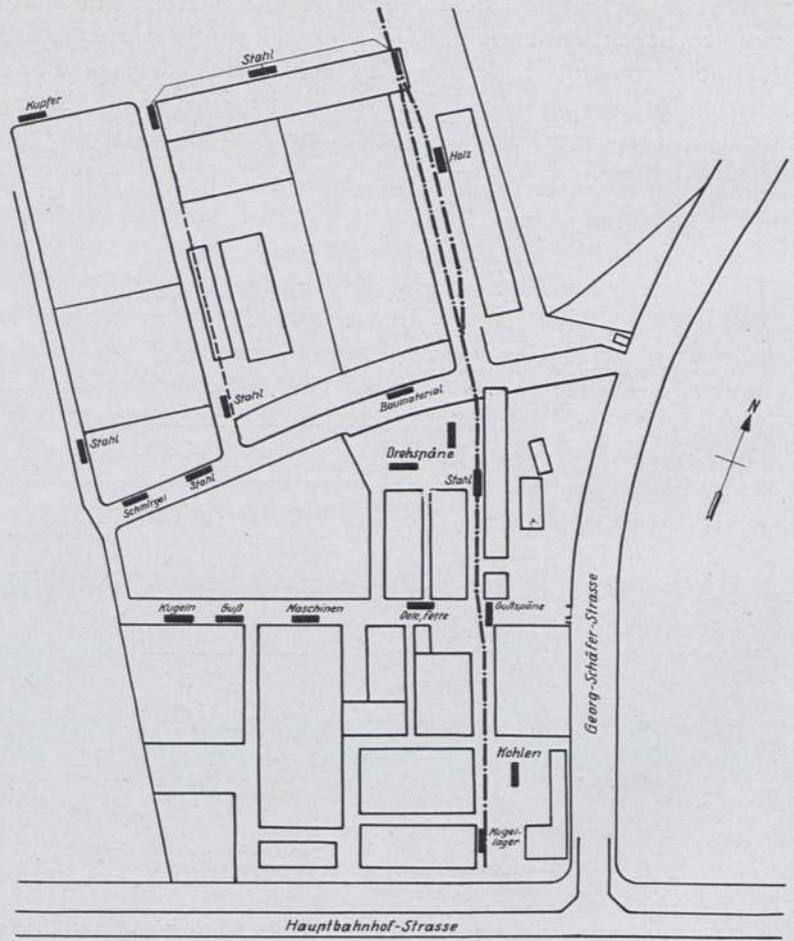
Lageplan des Werkhofes Kugelfischer, Schweinfurt, mit 20 Ladestellen.
